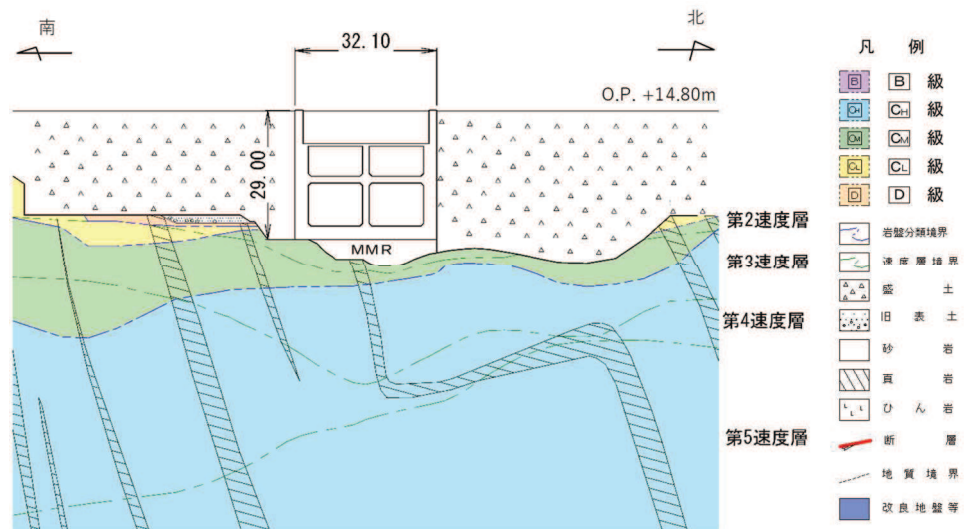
第 3 号機海水ポンプ室の地質断面図 (㉕-㉕断面)
